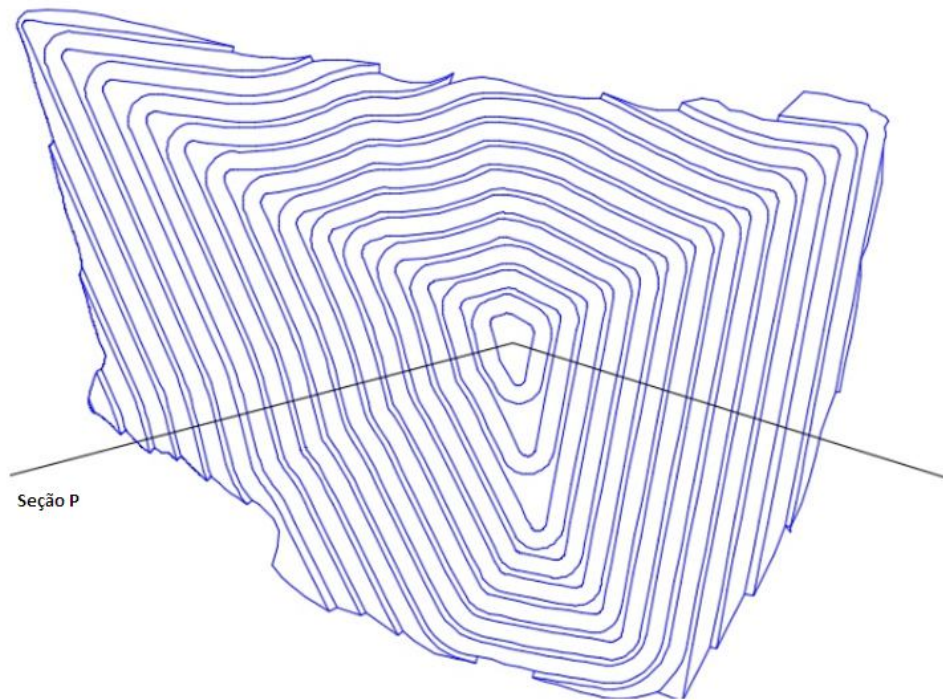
Arranjo da Pilha com o traçado da seção principal
